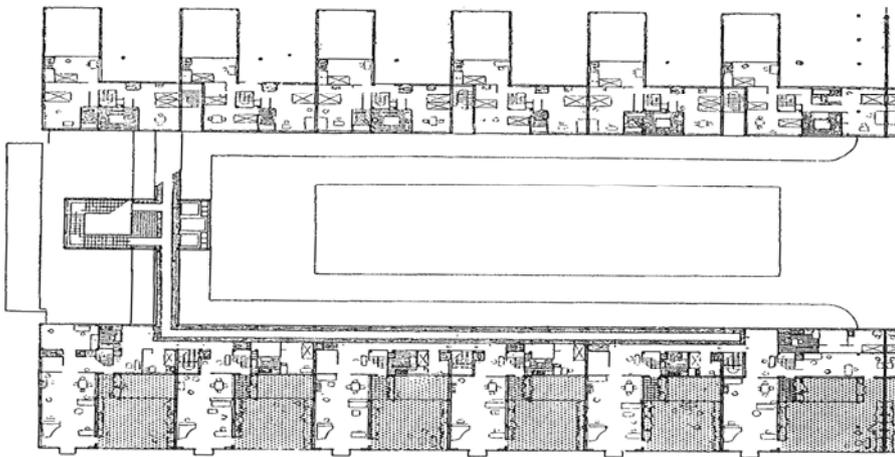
Grundriss eines Villenblocks (l)
